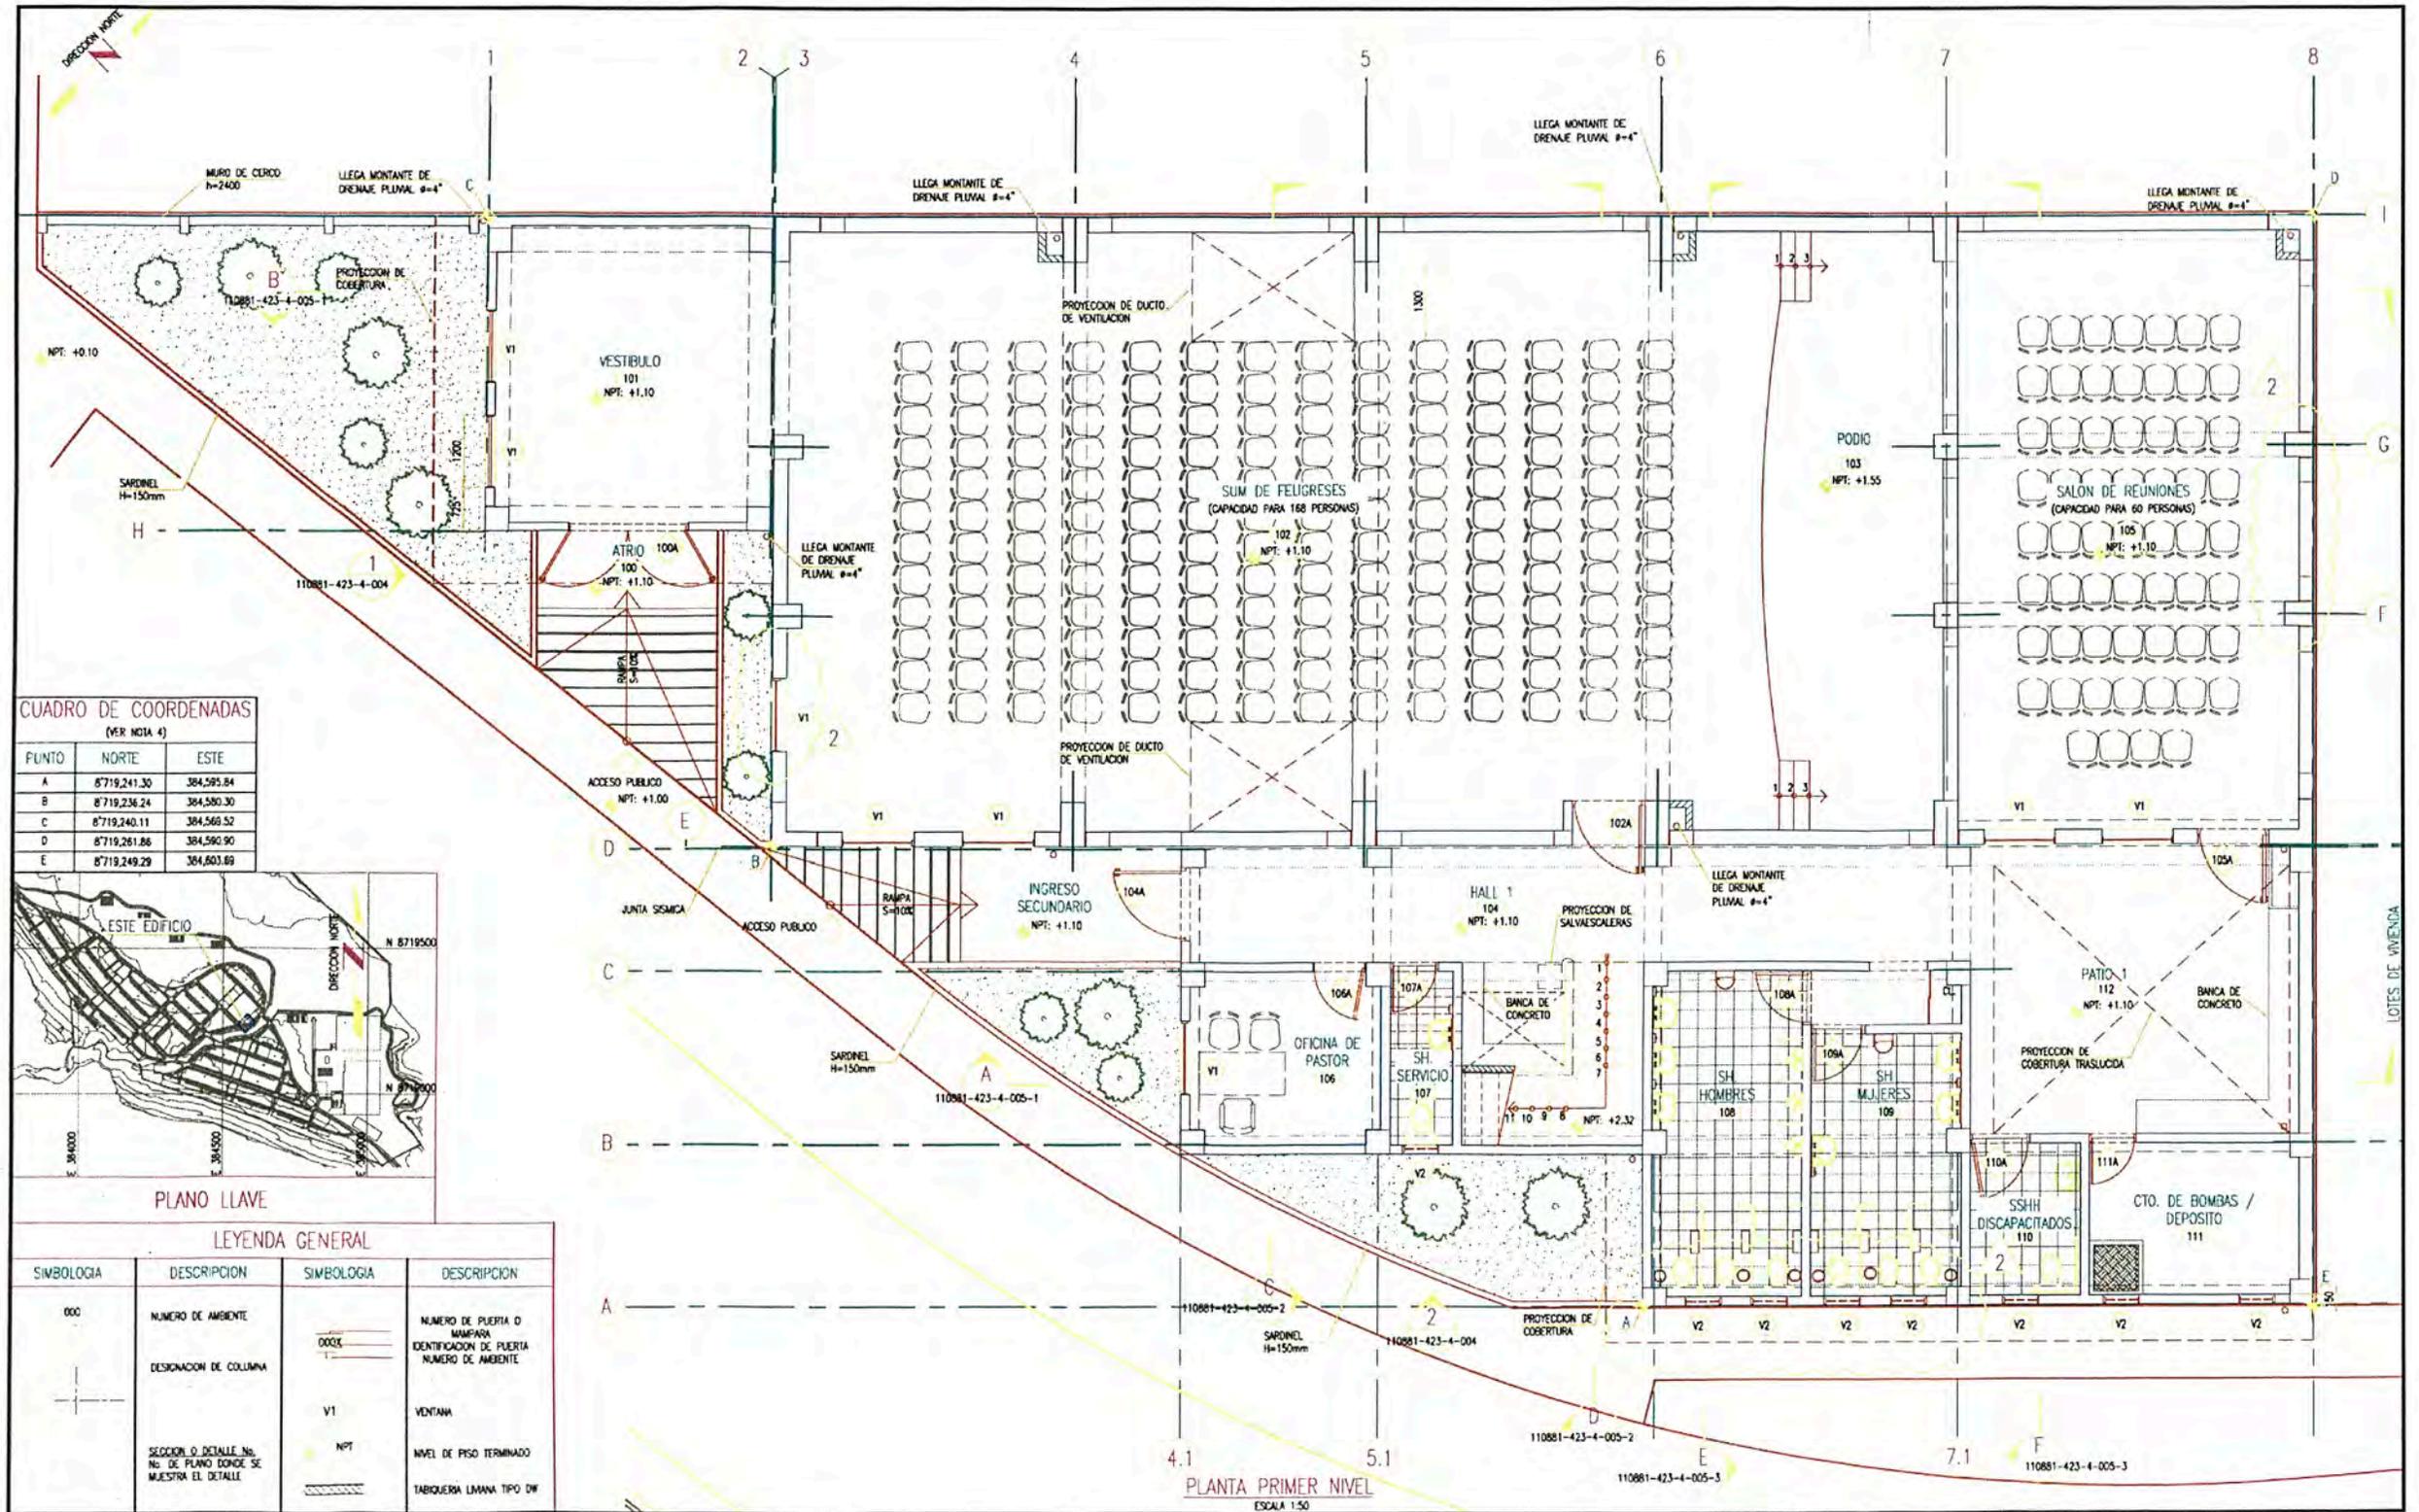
Plano de Arquitectura, planta primer nivel
